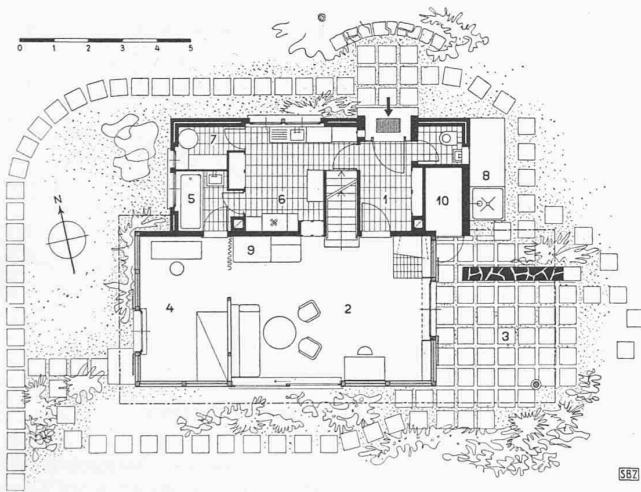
Grundriss des Hauptgeschosses, 1 : 200. Legende im Text
